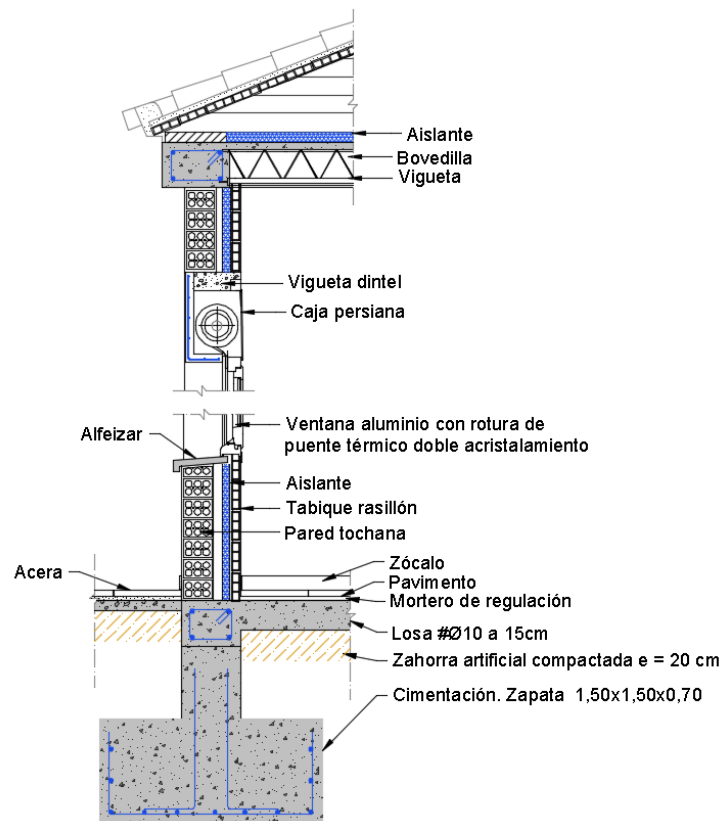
Sección Tipo de Fachada en Edificio de Control
